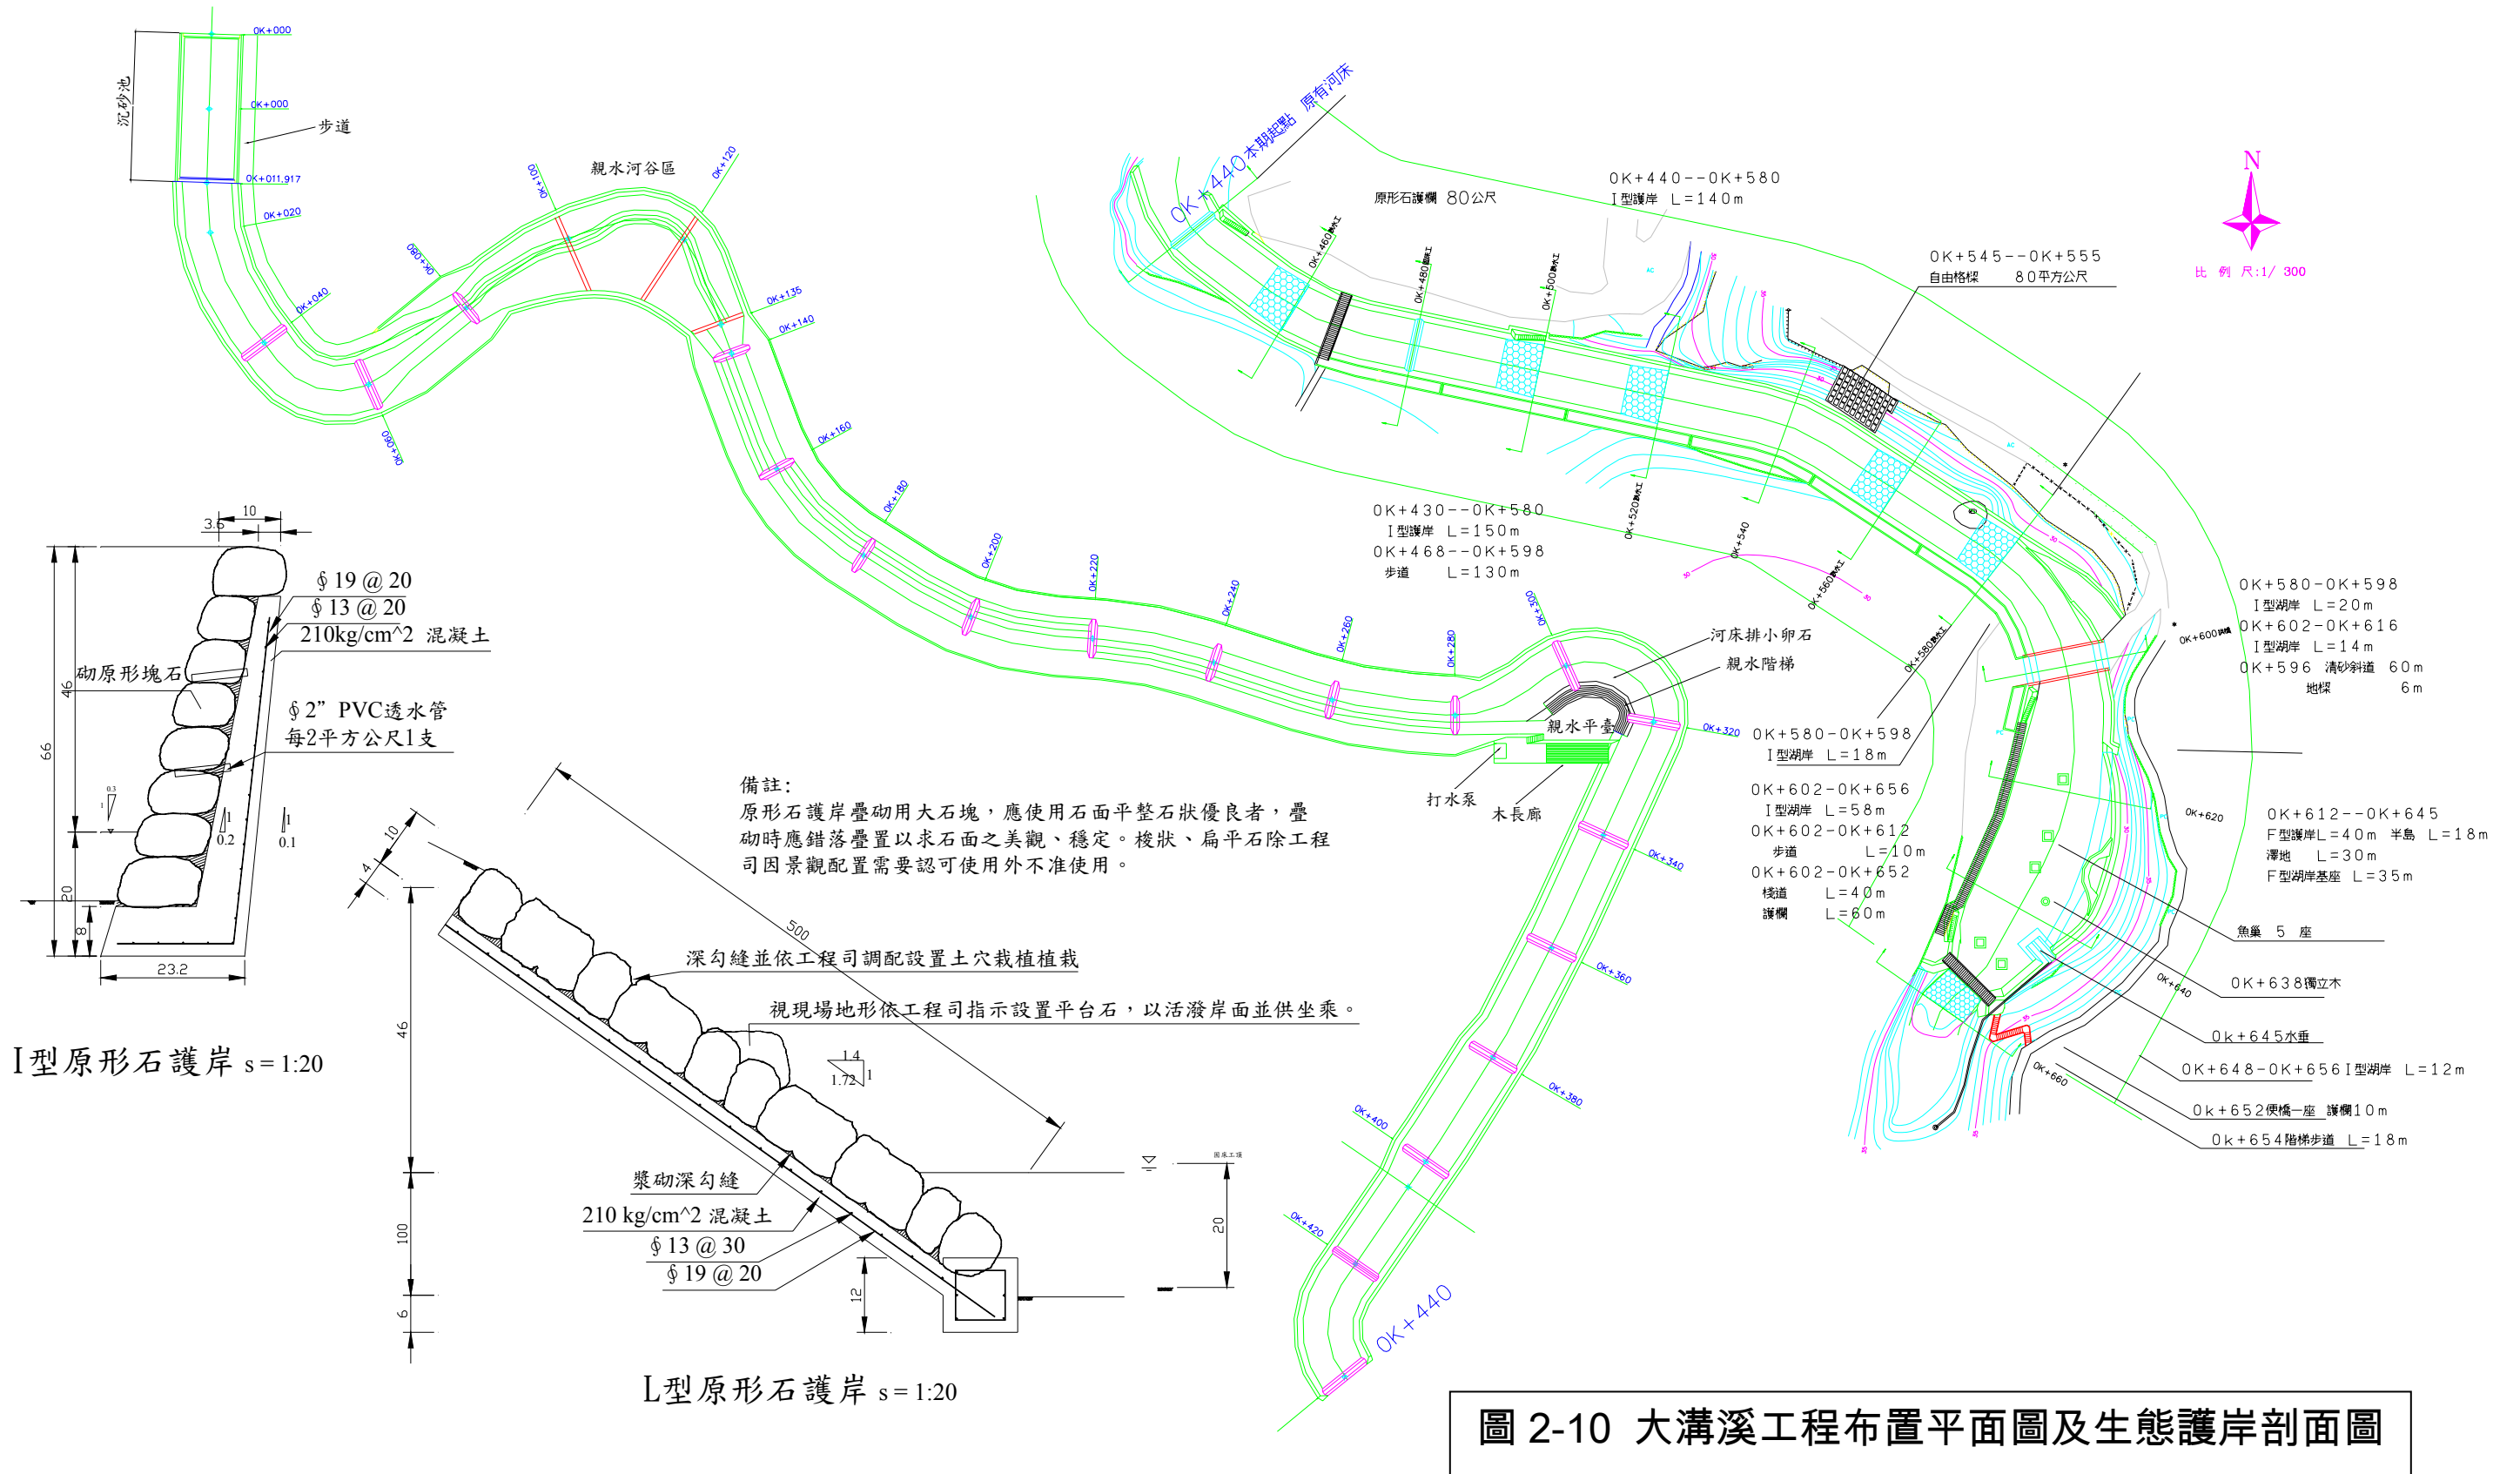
大溝溪工程布置平面圖及生態護岸剖面圖
